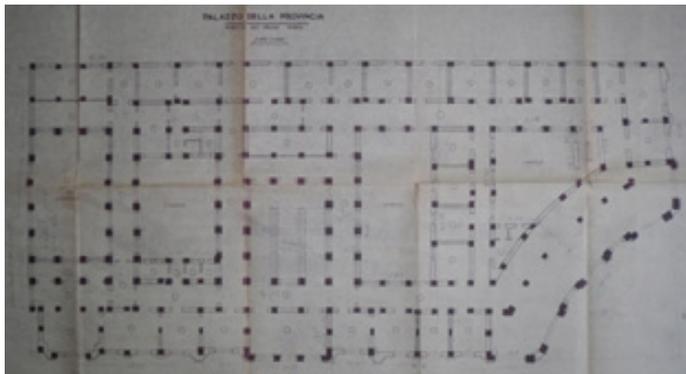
Pianta originaria nella quale è tracciata l'ossatura in cemento armato con campi murari collaboranti.
